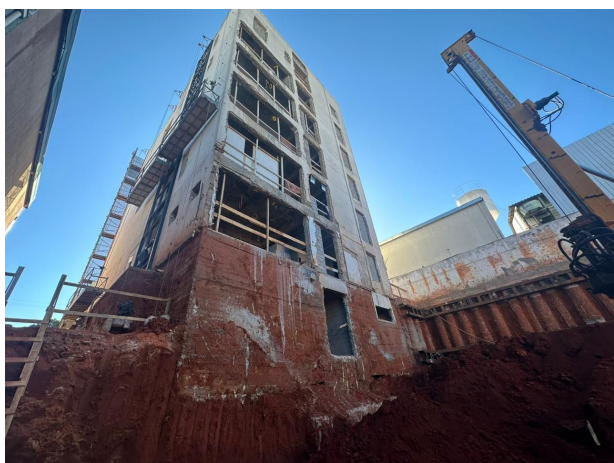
a 04 – Situações dos muros de divisa entre CFMV e vizinhança, observado em Laudo de Vizinhança
